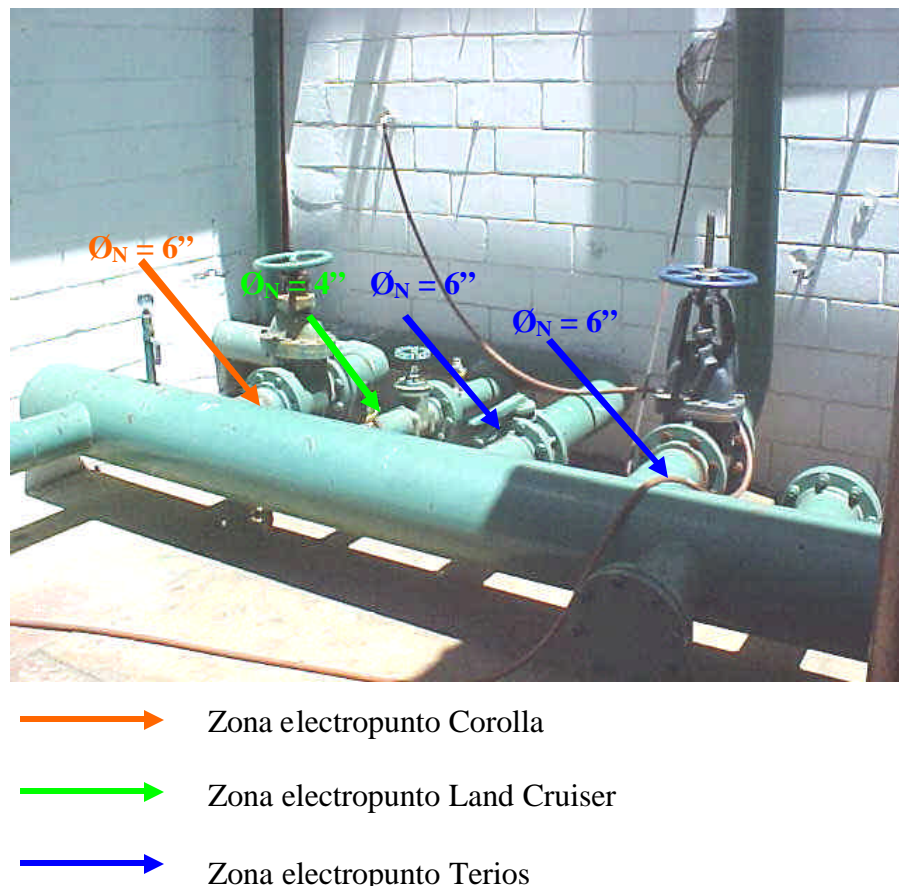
Tuberías de suministro del sistema de enfriamiento instalado
